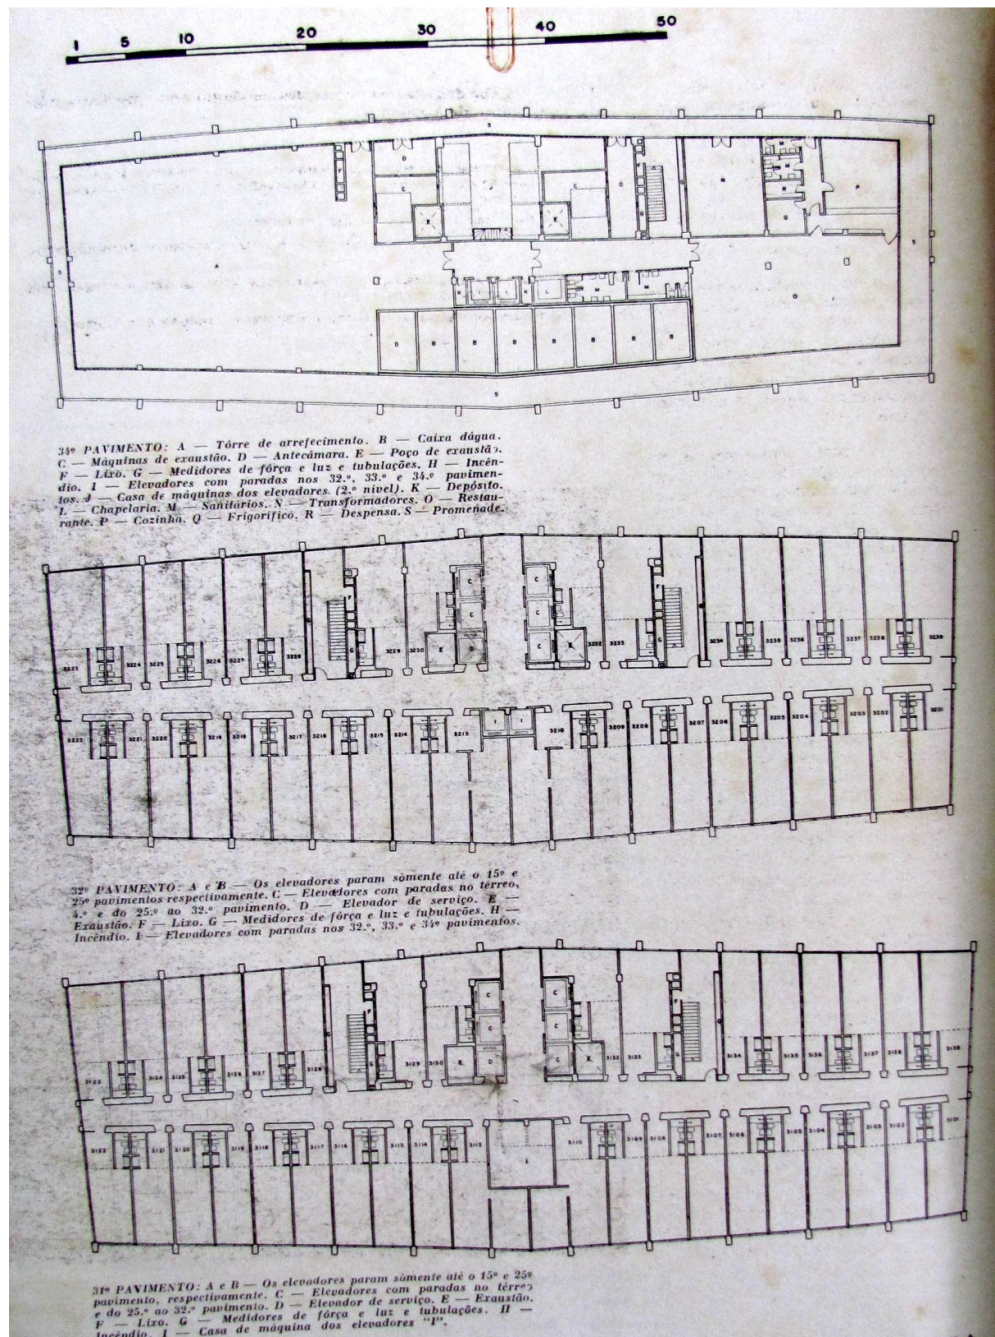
H – Variações de plantas baixas de pavimentos tipo da torre e planta bx. do último andar (desenhos com deformações devido a limitações de reprodução)
